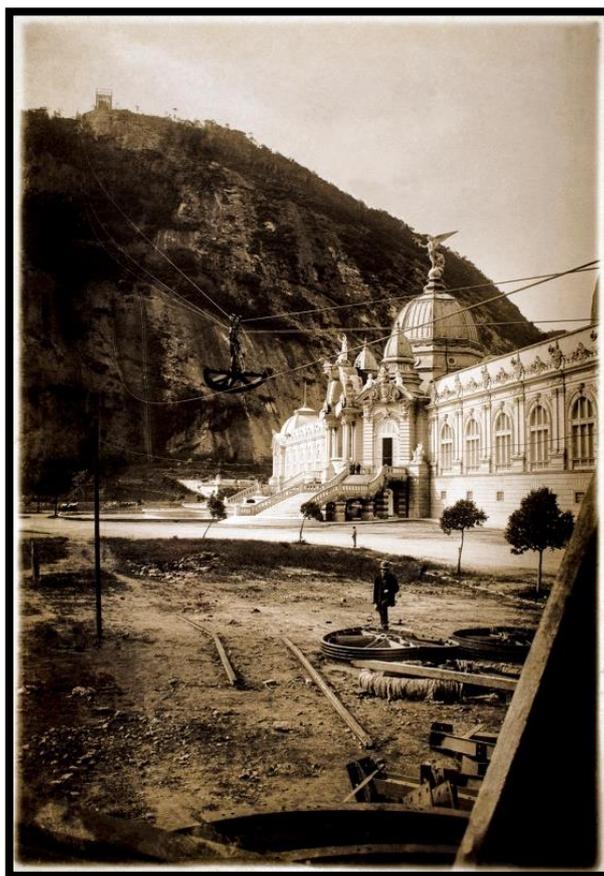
Foto Alonso Bispo. Canteiro de obras da Praia Vermelha em 1910. FONTE: Acervo CCAPA.
